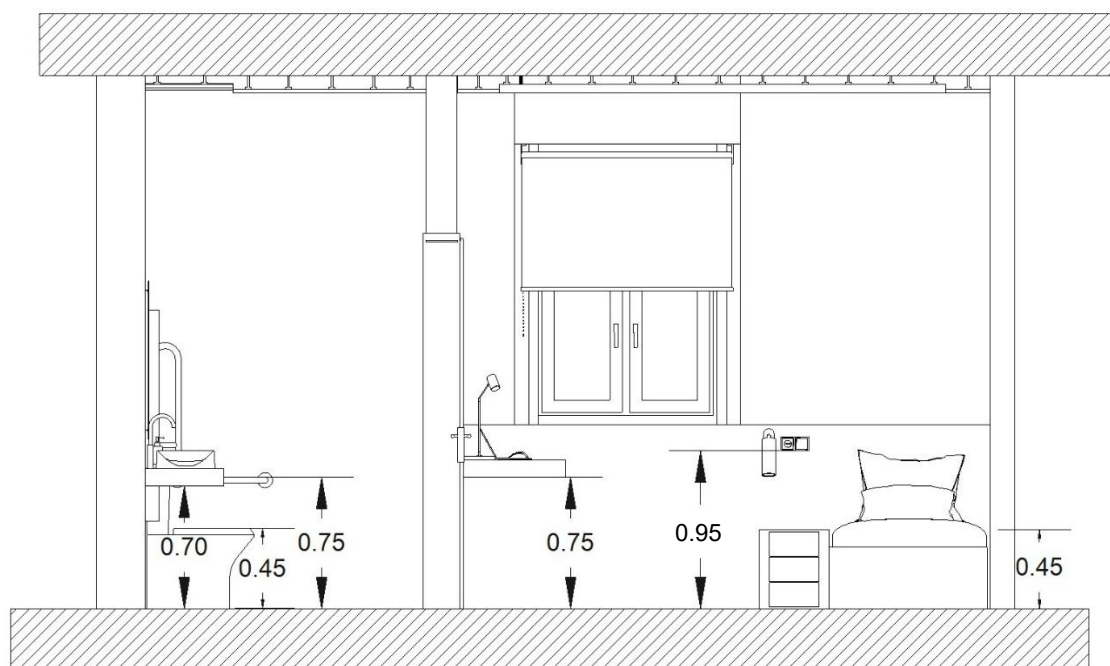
Corte com Cotas Verticais; Fonte – Daniel Silva
